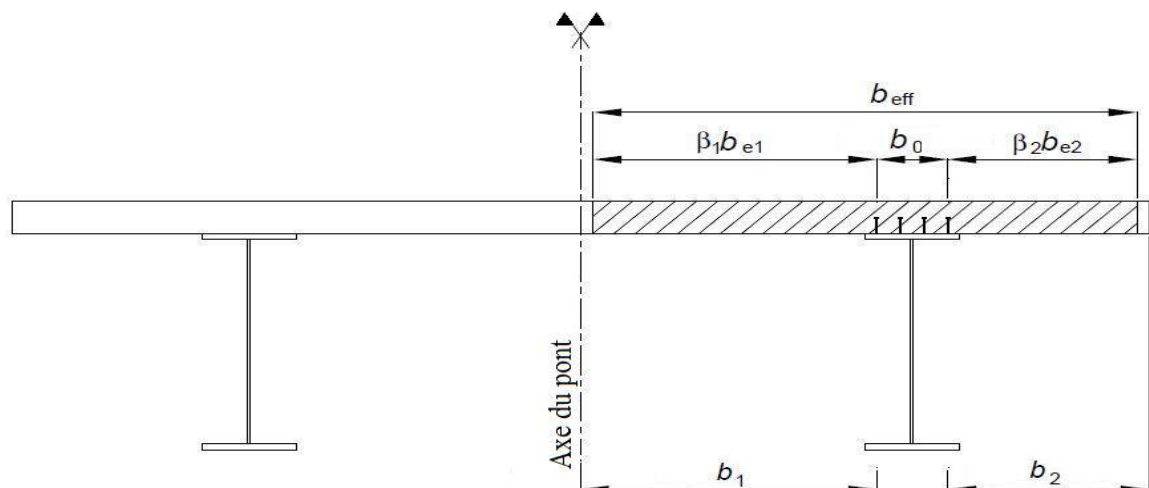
Largeur efficace de dalle dans une section de poutre principale du pont bipoutre
